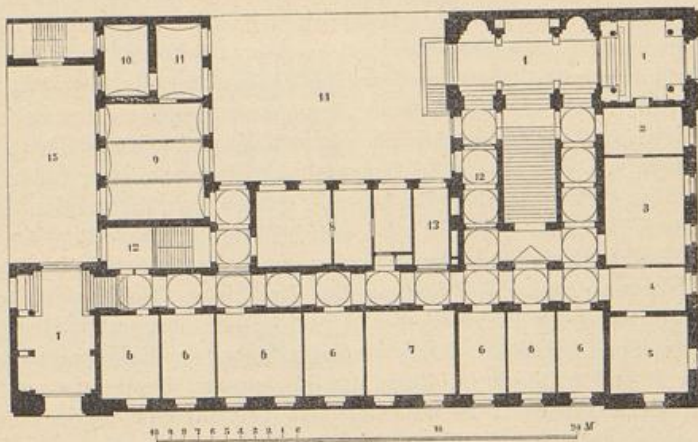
Grundriss vom Erdgeschoss.
